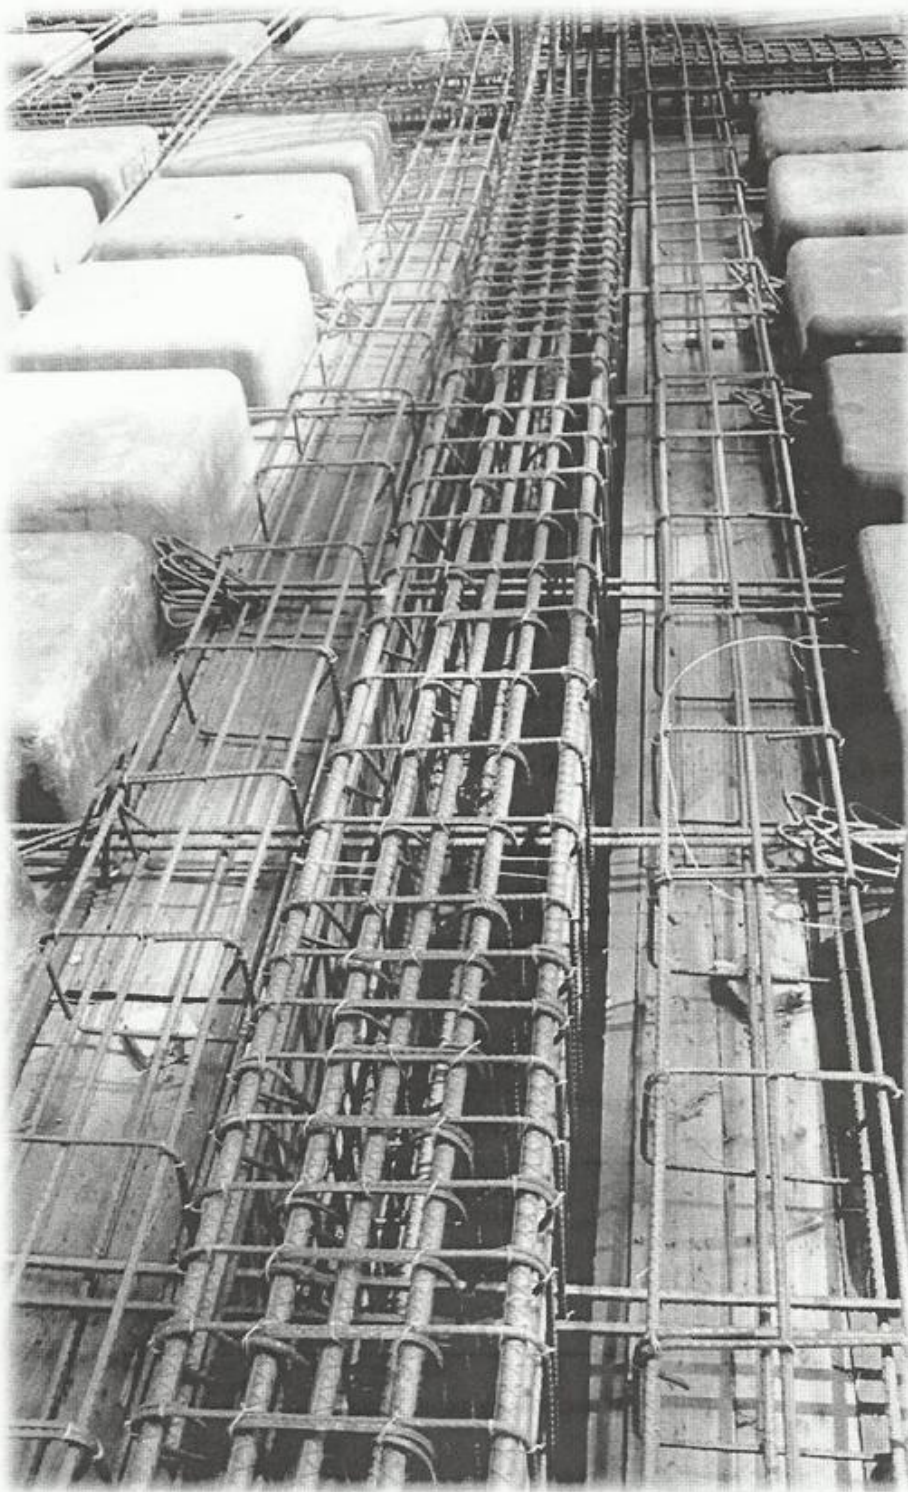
Detalle de una viga en una estructura sismo-resistente
